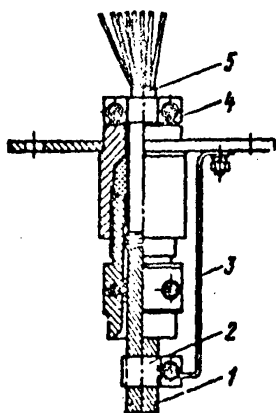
Схема заземления контрольного кабеля со свинцовой оболочкой:
